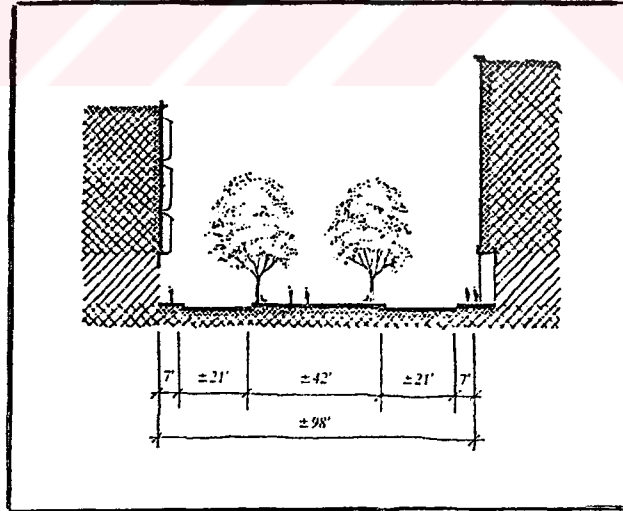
Ringstrasse Caddesi - Plan (Ölçek: 1/600)
